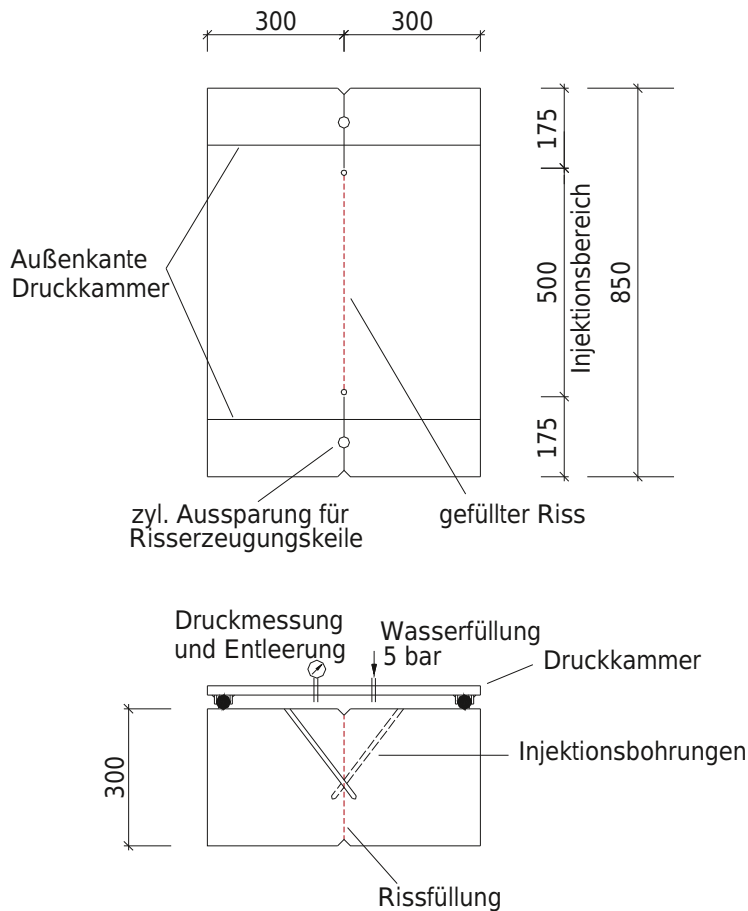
Prinzipskizze Probekörper; oben: Draufsicht, unten: Schnitt
